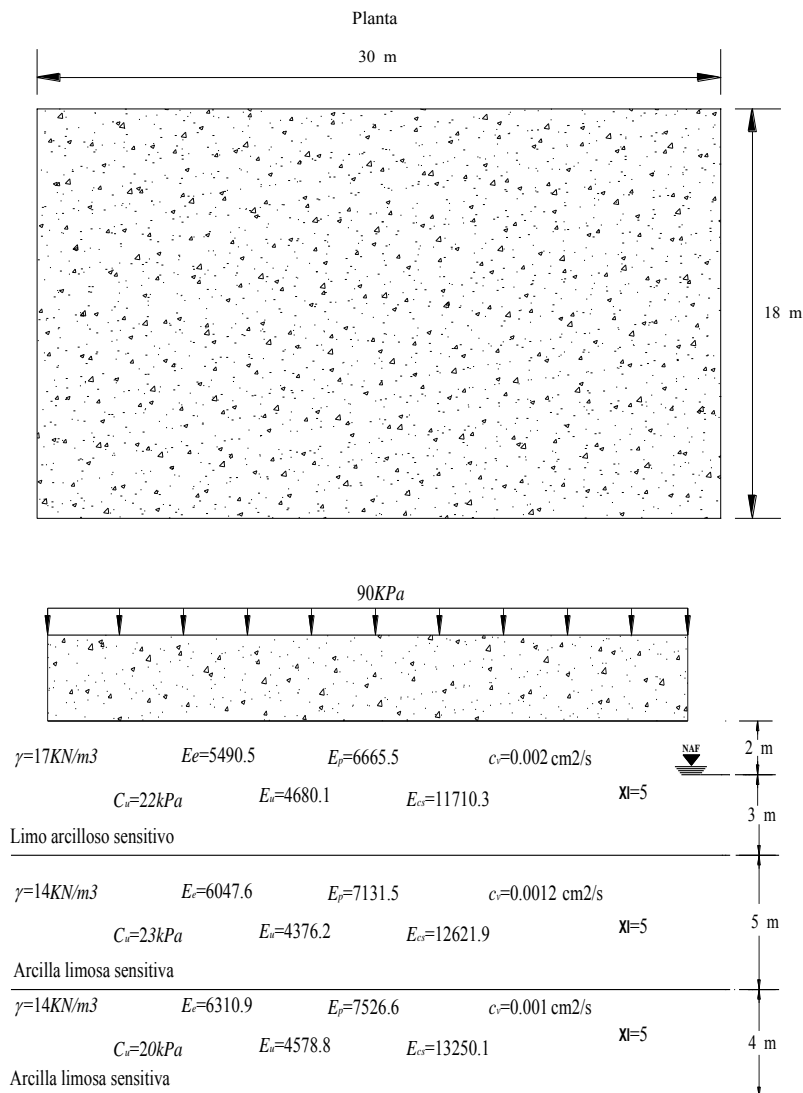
Vista en planta de la cimentación y perfil estratigráfico bajo la misma.
